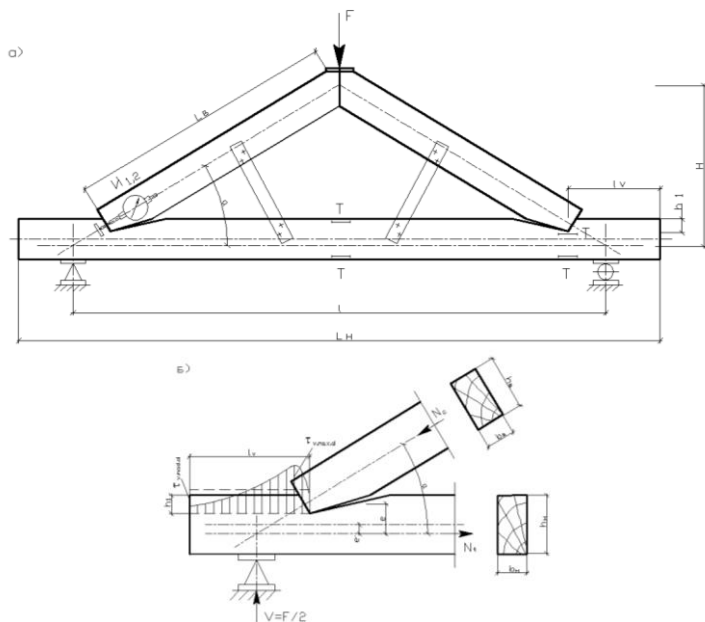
Конструкция треугольной фермы на лобовых врубках:
